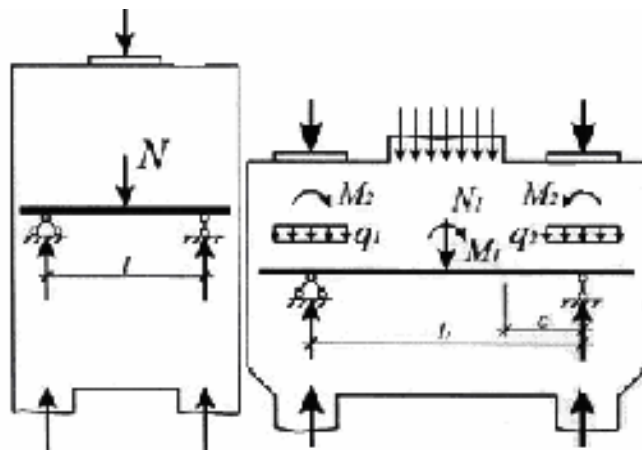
Расчетные схемы перемычек и ригелей двухветвевых колонн, принятые СНиП 2.03.01–84
